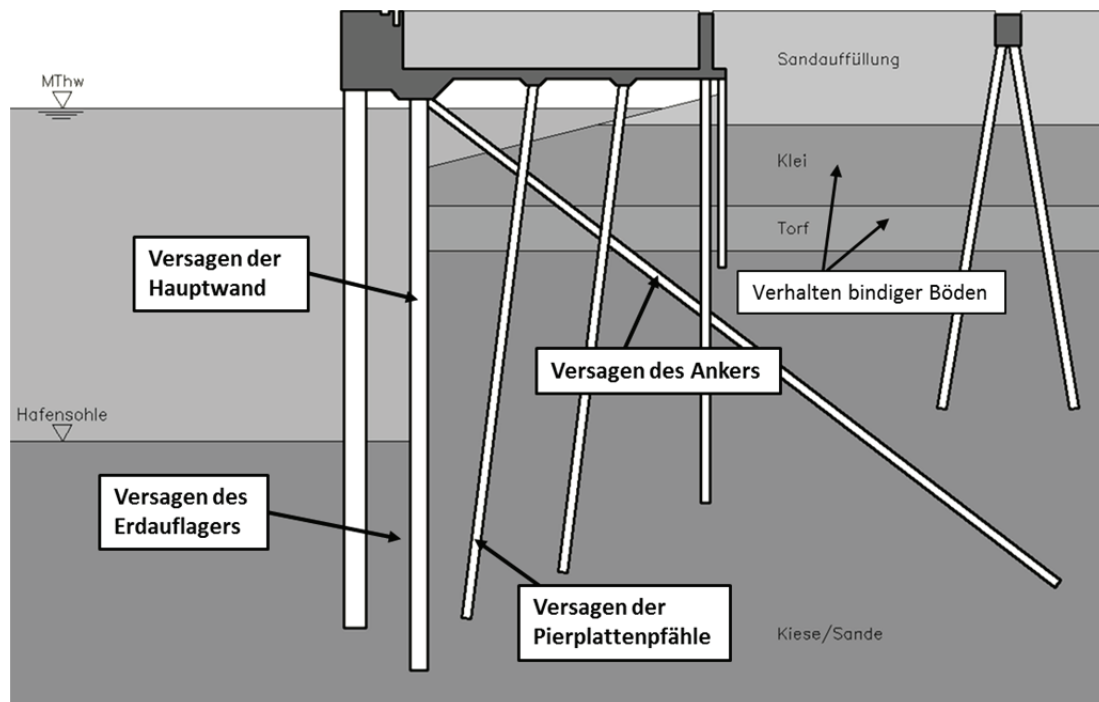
exemplarischer Querschnitt einer Kaianlage und bodenmechanisch relevante Versagensformen
